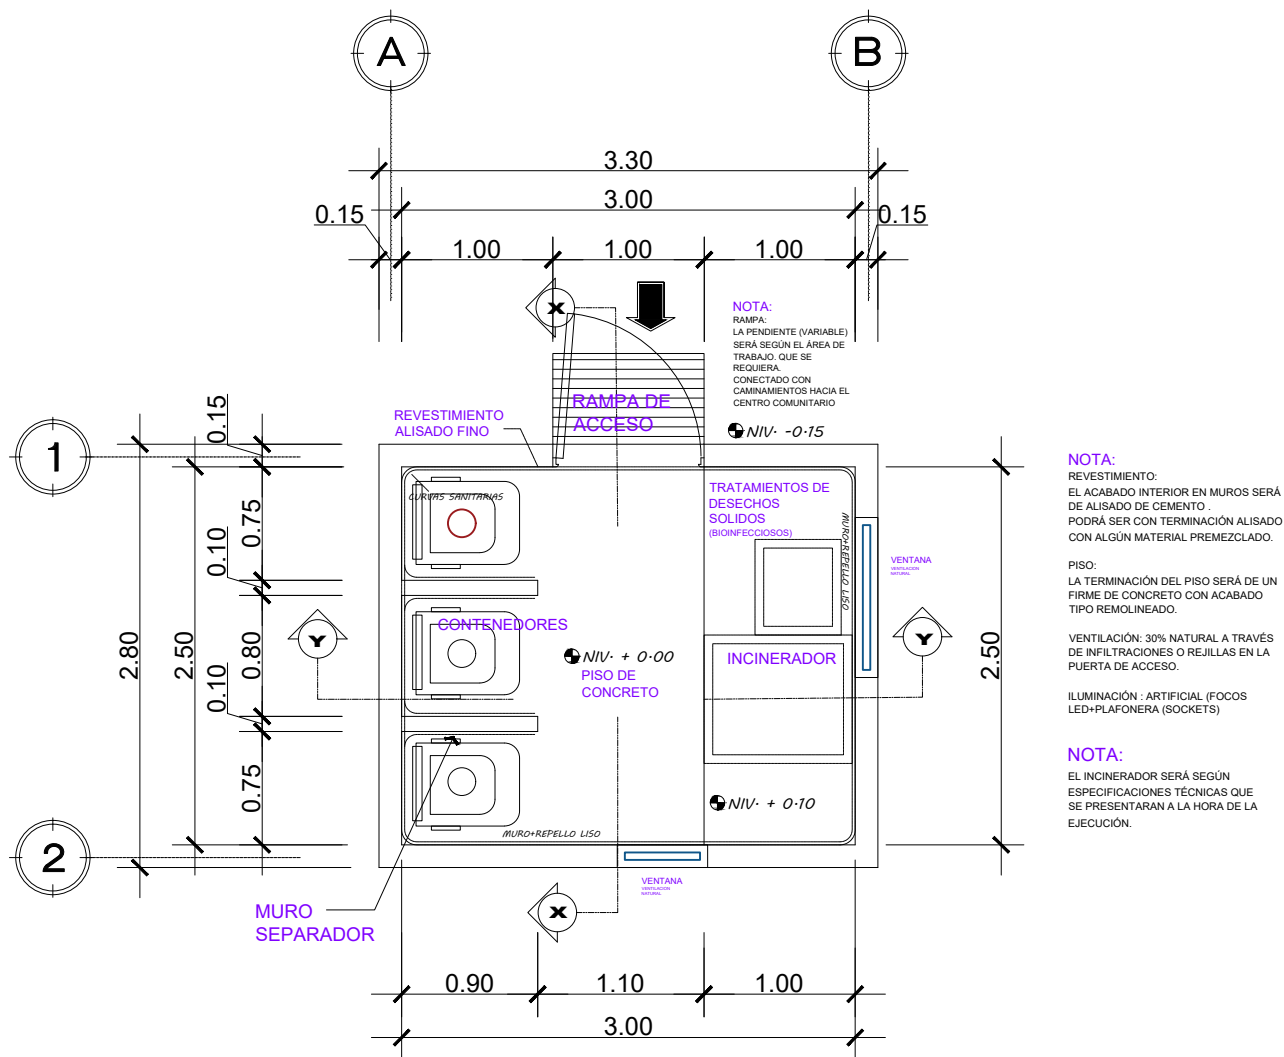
Planta de distribución de un centro de acopio propuesto | Crédito: equipo consultor.
